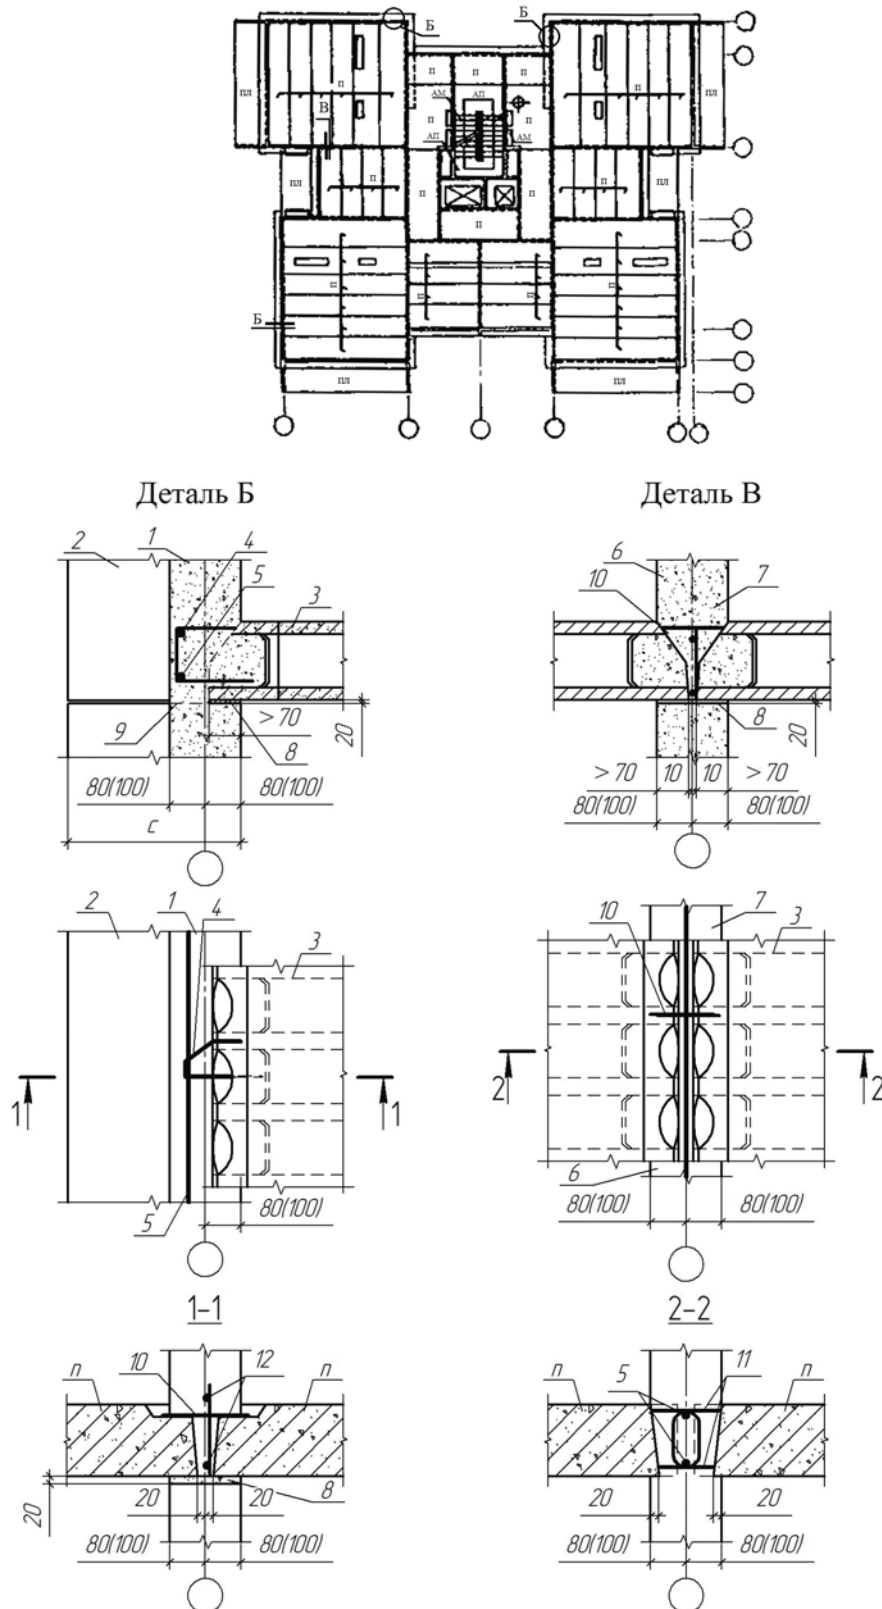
Сборное перекрытие из железобетонных плит:
